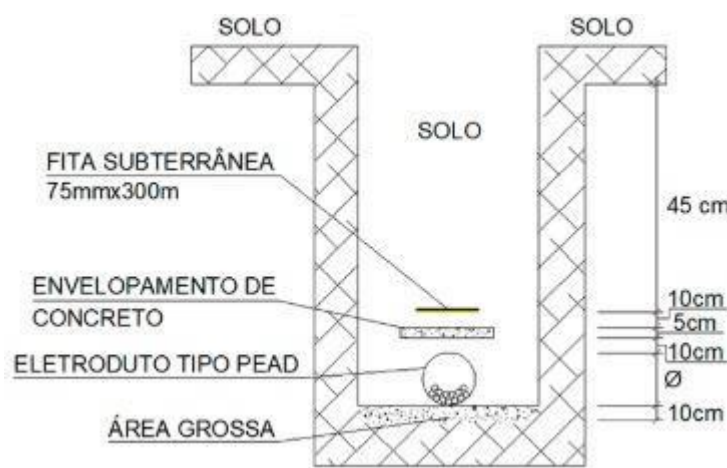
Detalhamento de Calha em concreto para infraestrutura em cabeamento elétrica.
